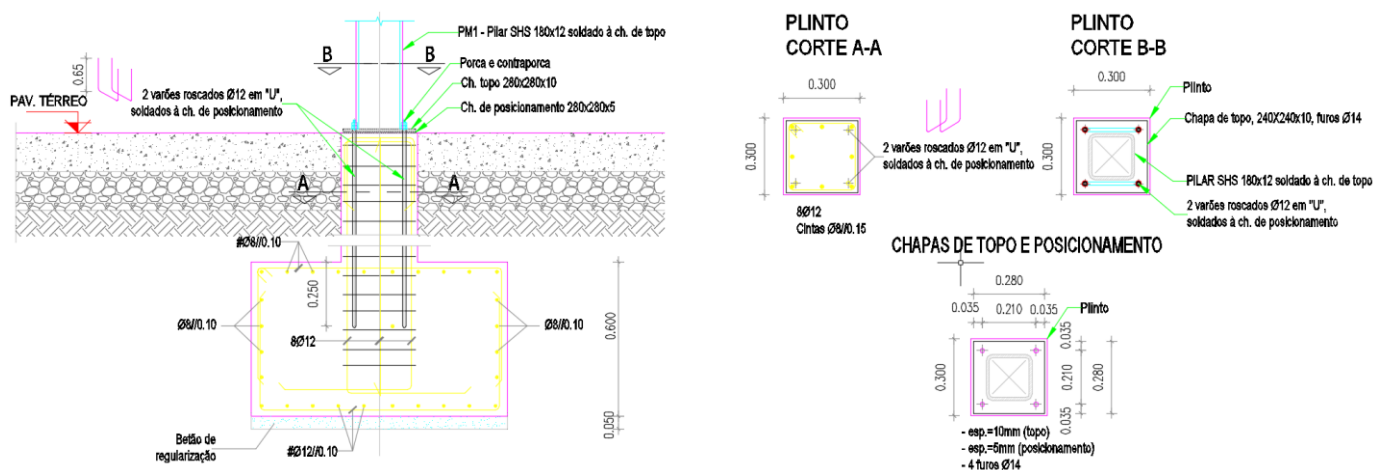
Pormenor da Execução das Sapatas, Plintos e respetivas ligações com os Pilares SHS 180
